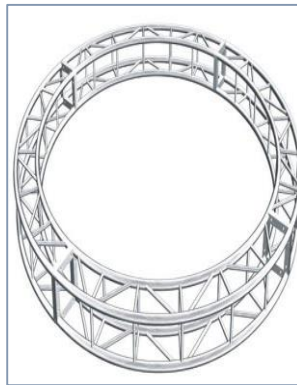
Poutre tridimensionnelles utilisé dans notre projet
